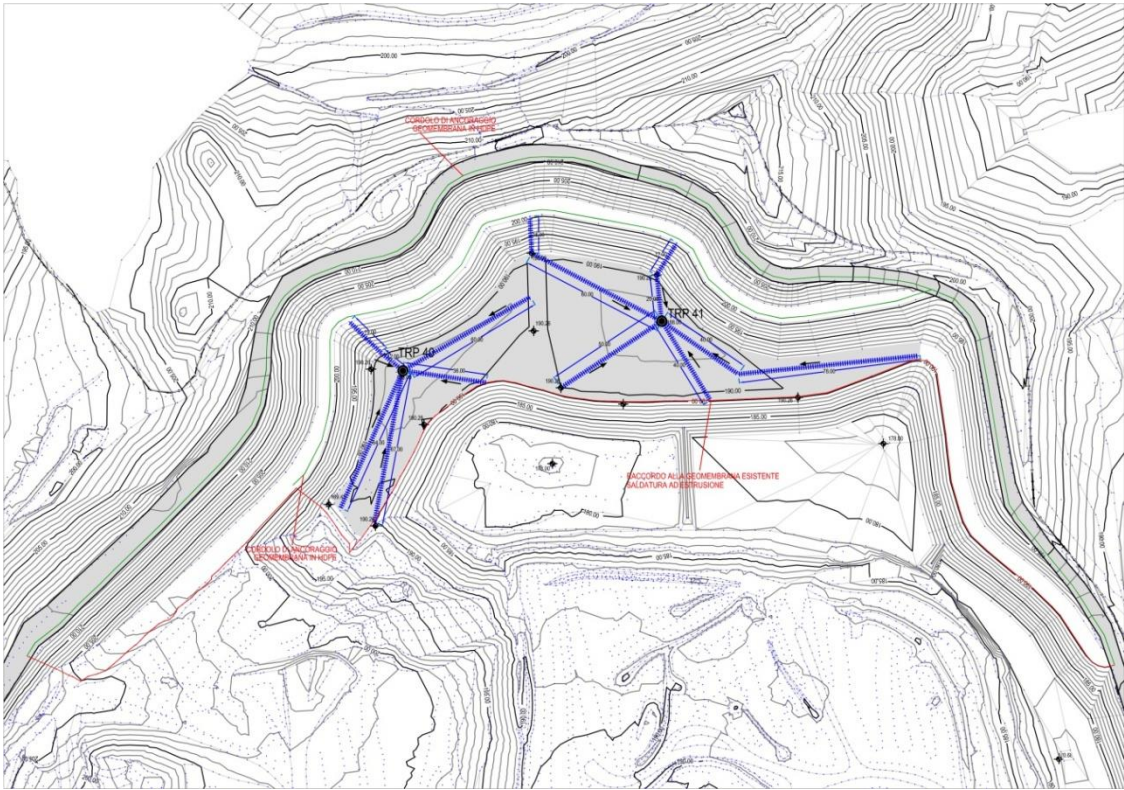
moduli di stoccaggio - drenaggi di fondo
